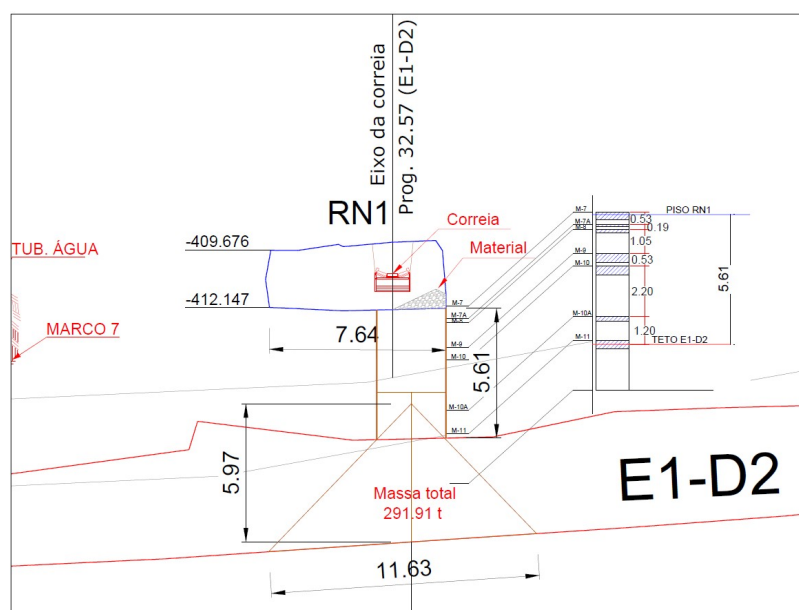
Detalhe do projeto de chute de descarga E1-D2.
